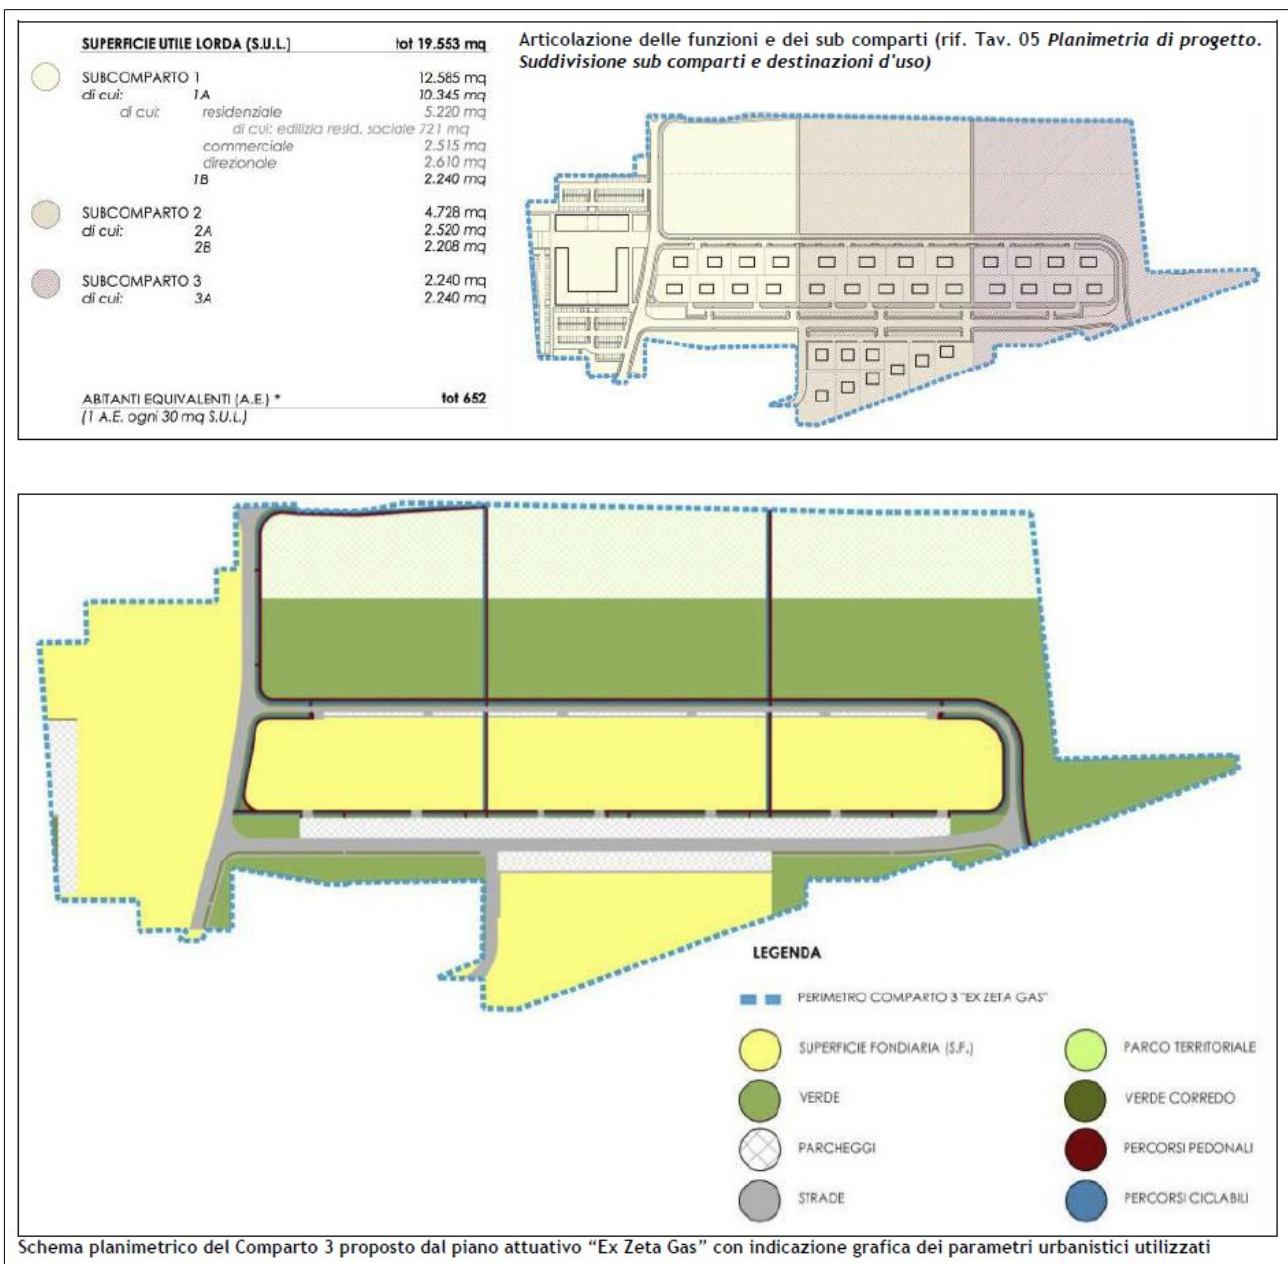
Planimetria generale Piano Attuativo "Ex Zeta Gas"
